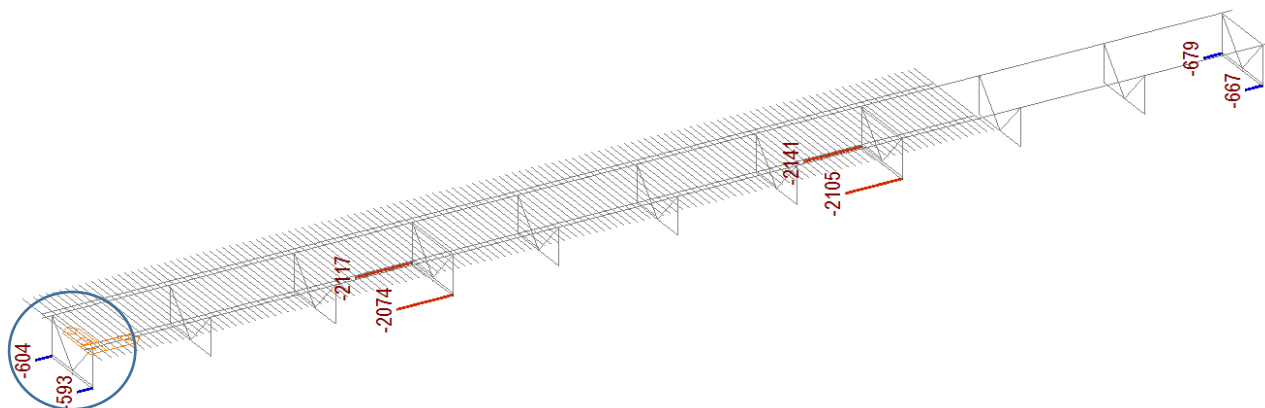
Betonážní úsek 1 (min. přitlak 125 kN, Podpěra 4)
